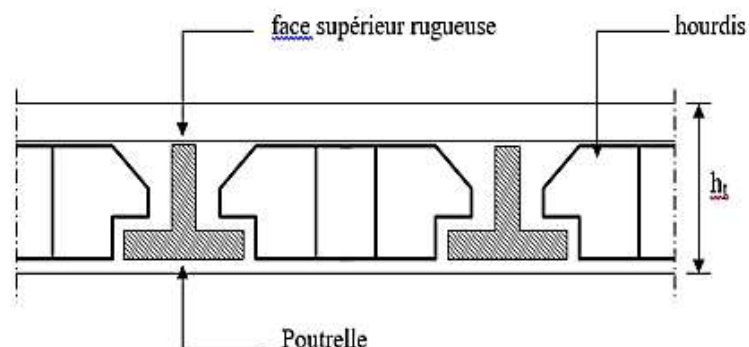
Coupe verticale du plancher à corps creux (20+4).
